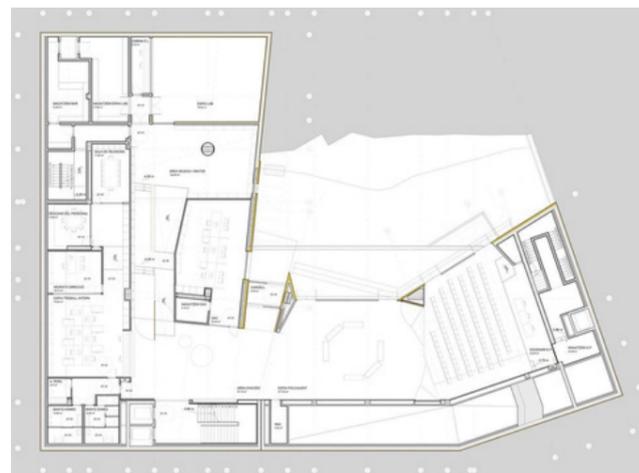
Subterráneo 1 Biblioteca Pilarín Bayés
